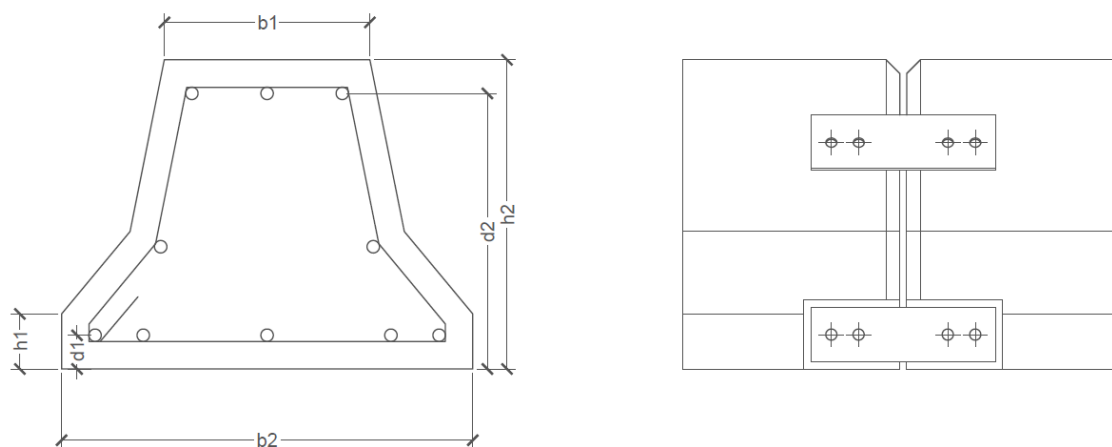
Fondazione prefabbricata di tipo “New Jersey”
